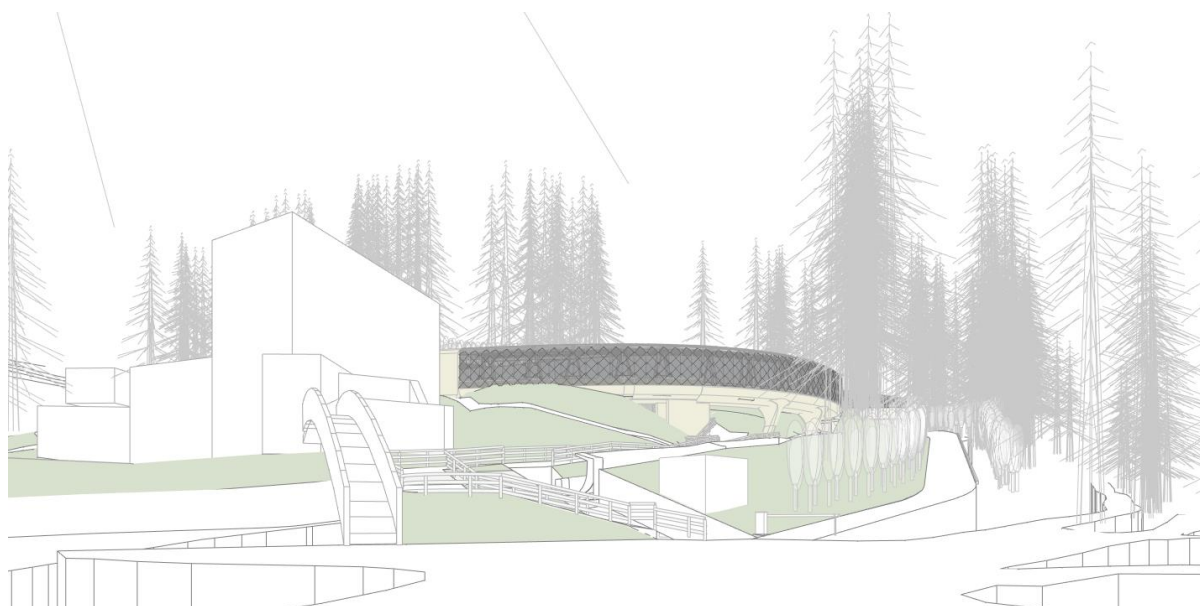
Vista di progetto dal parcheggio zona Palestra di Roccia
